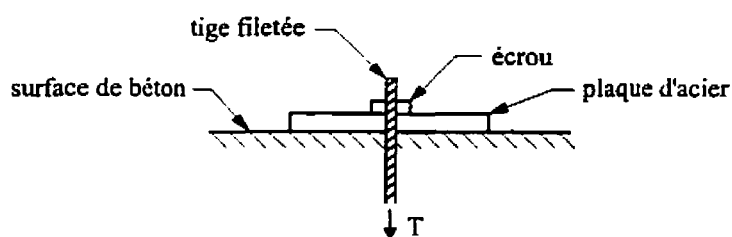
Système de serrage de la poutre de fondation à la table vibrante.
